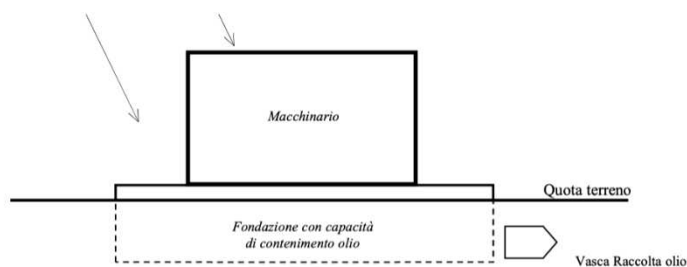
Rappresentazione schematica del sistema Vasca Fondazione
